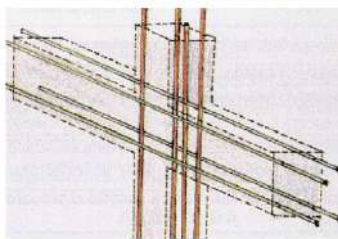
Unión de castillos con las cadenas de cimentación y dalas
